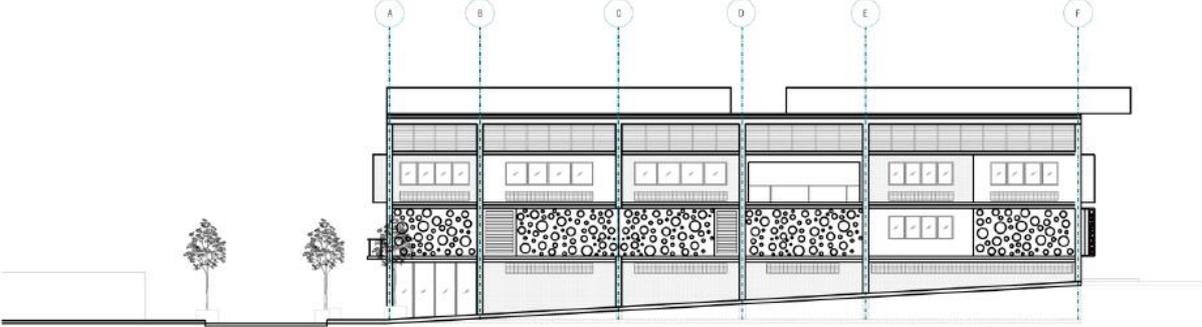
Fachada lateral derecha. Fuente: Elaboración propia
